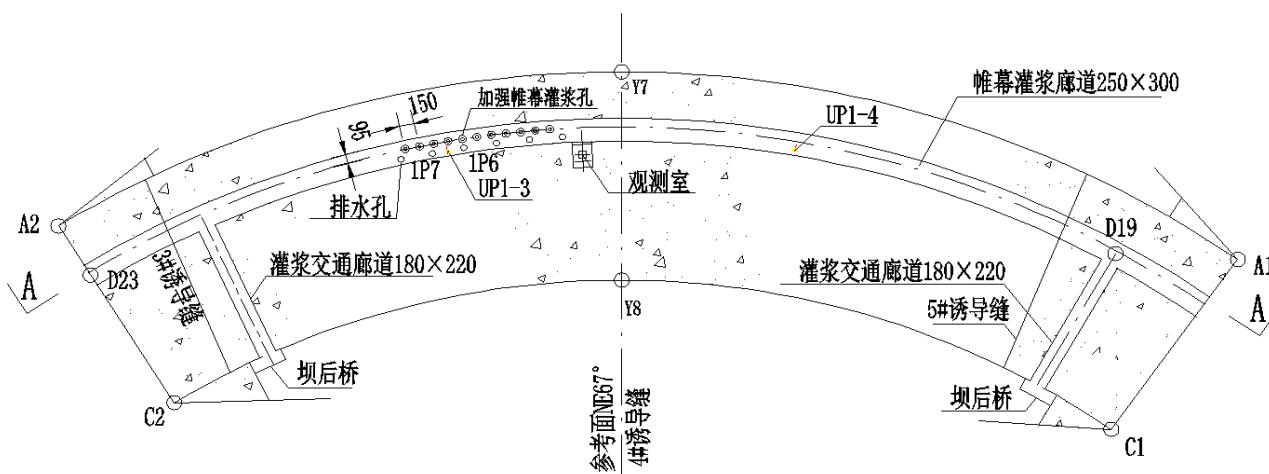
坝基帷幕补强处理灌浆孔布置平面图
